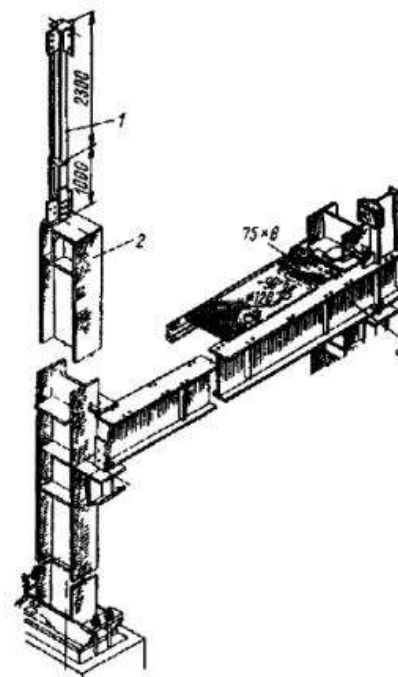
Основные узлы (монтажные) стального каркаса: 1 — надпорная стойка; 2 — стальная колонна постоянного сечения, 3 — подкрановая балка
